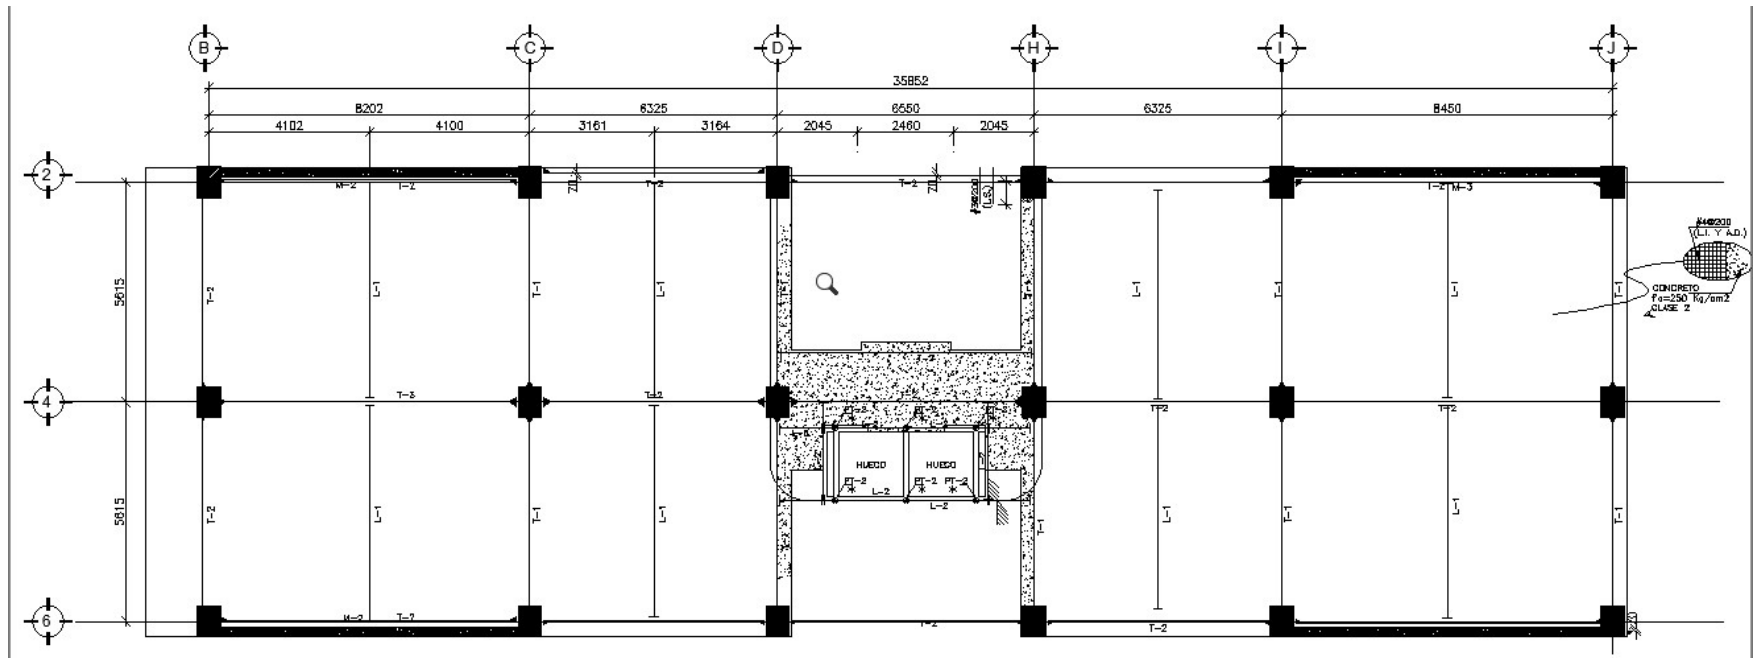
Planta estructural del edificio a base de concreto reforzado.
